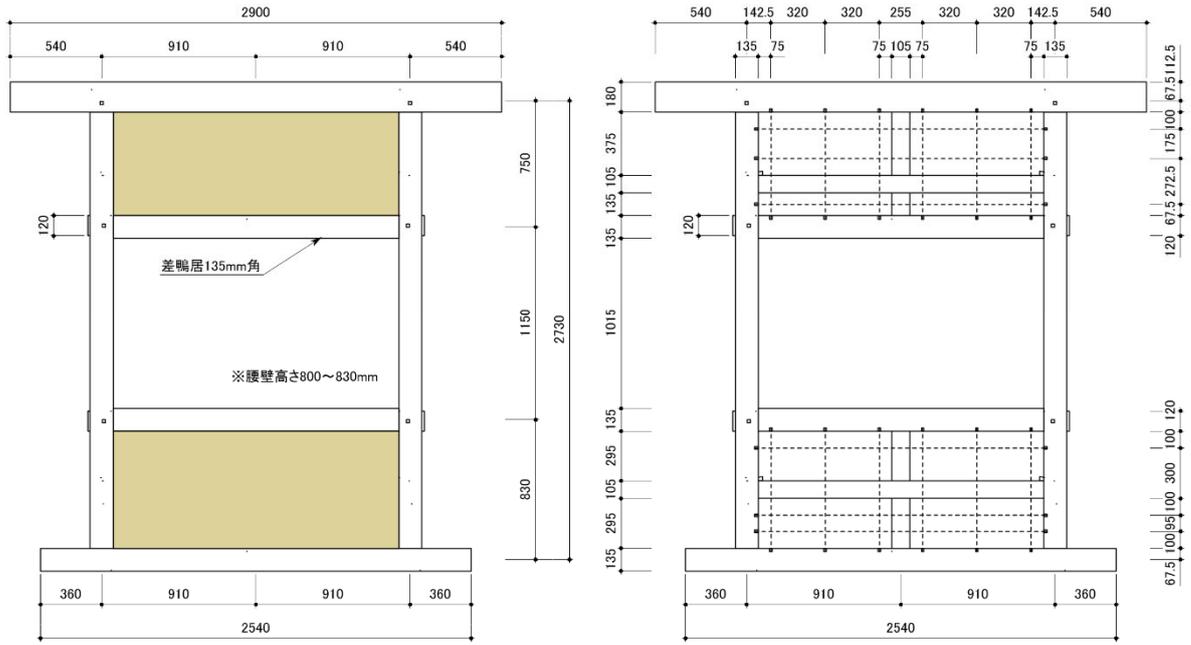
試験体 2 (垂れ壁+腰壁) 試験体詳細
